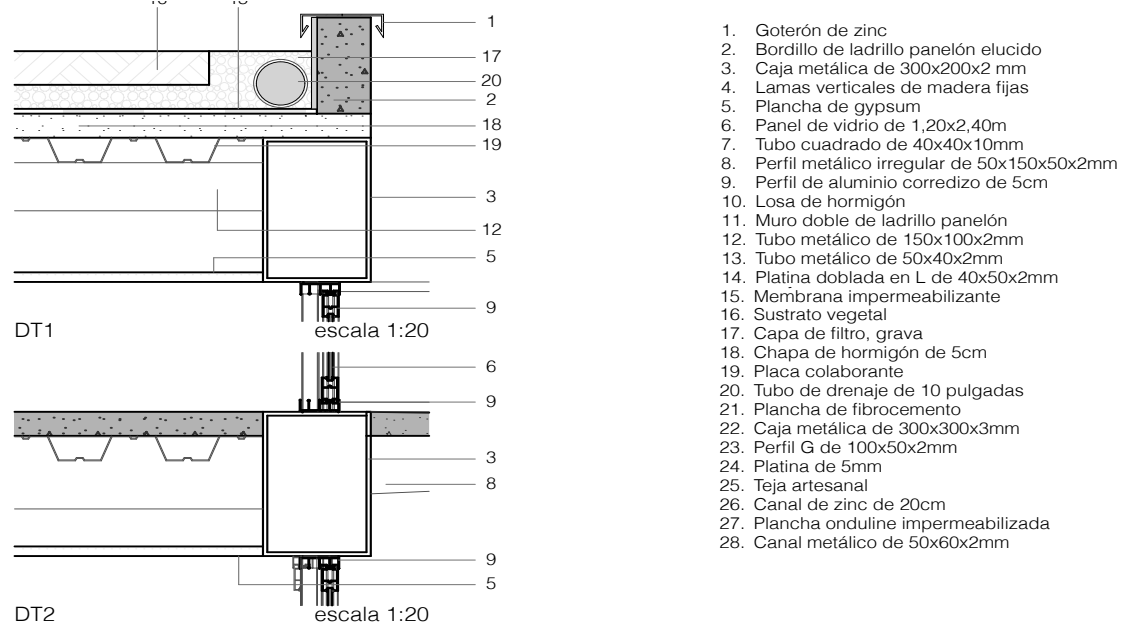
Imagen detalle constructivo Propuesta Conjunto Habitacional
